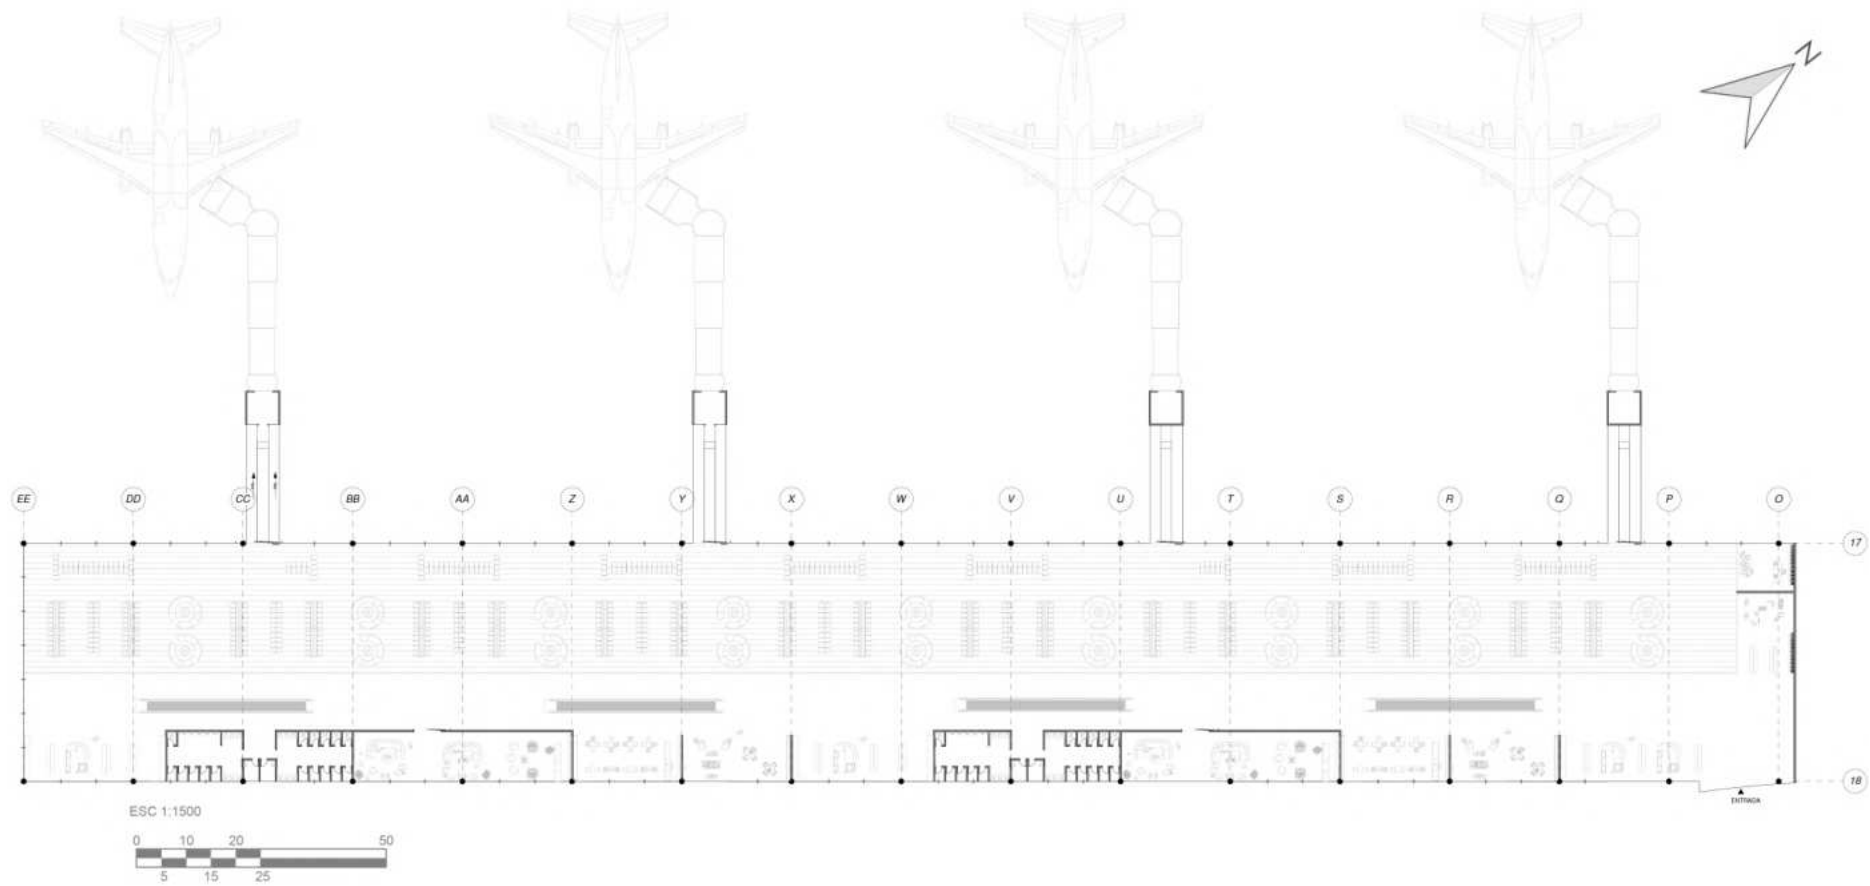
Planta Baja de terminal principal "Ver anexo 5"
